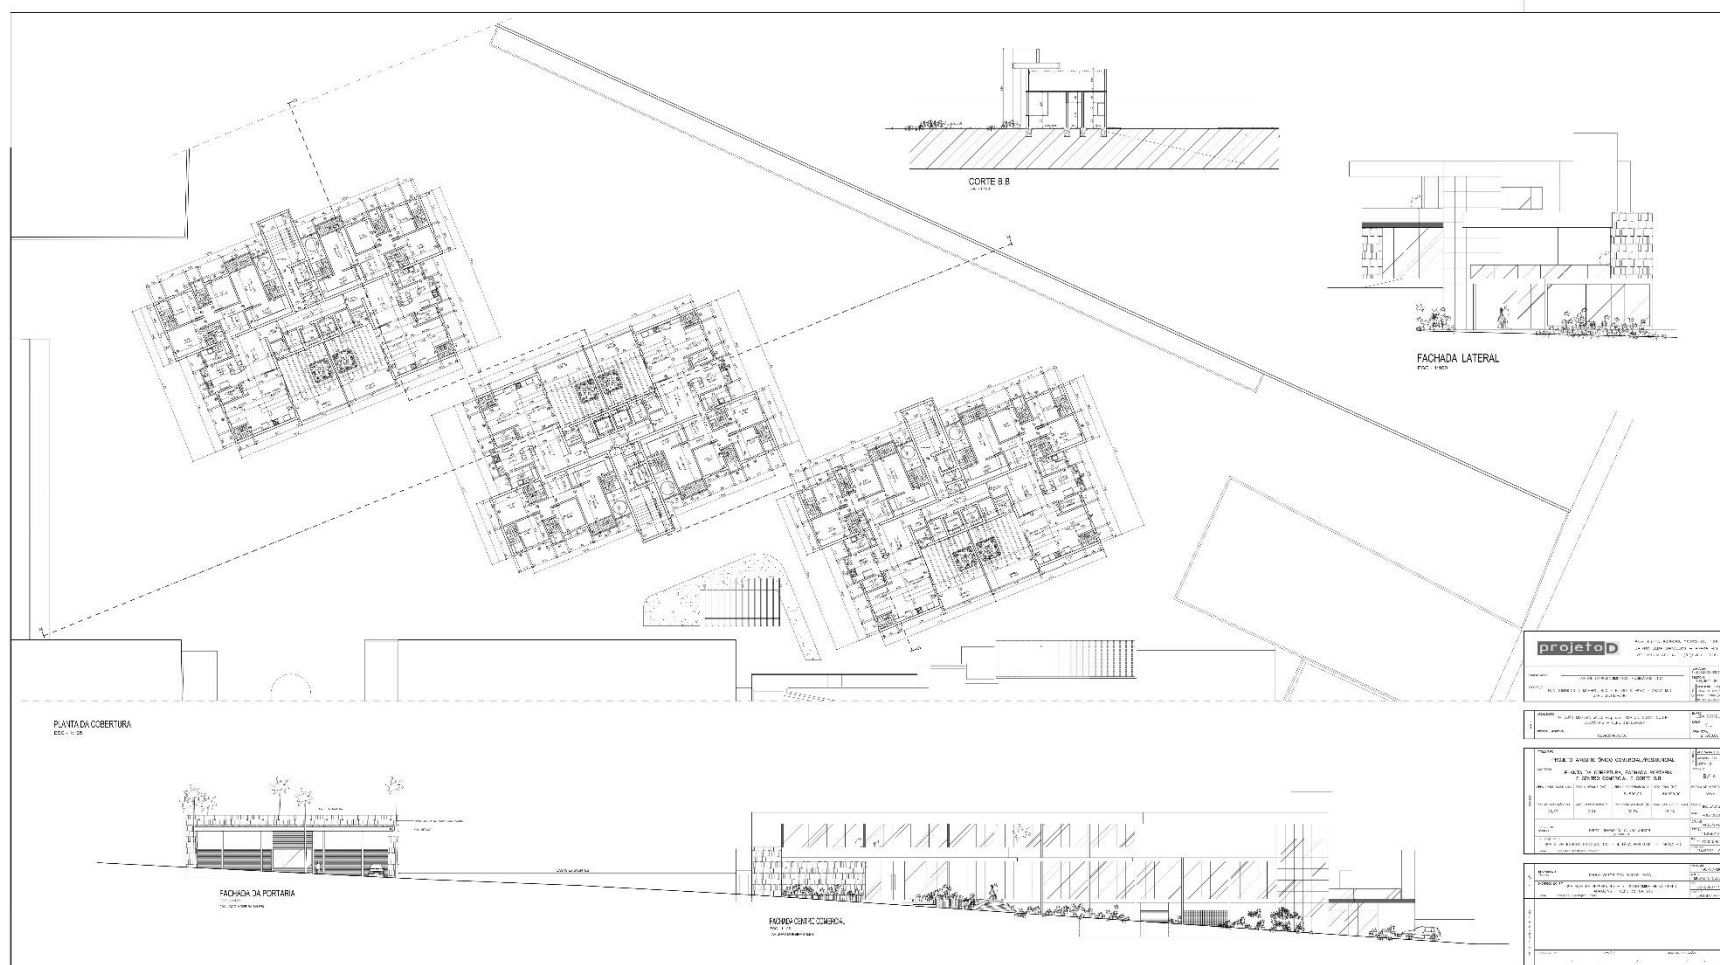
Planta da Cobertura, Fachada Portaria e Centro Comercial e Corte B.B.
